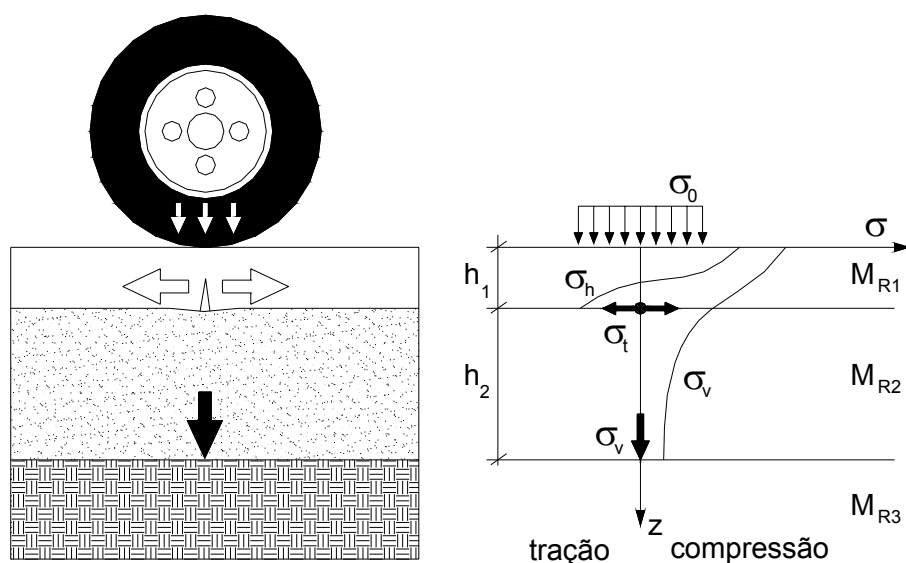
Tensões em um pavimento (MEDINA, 1997).
